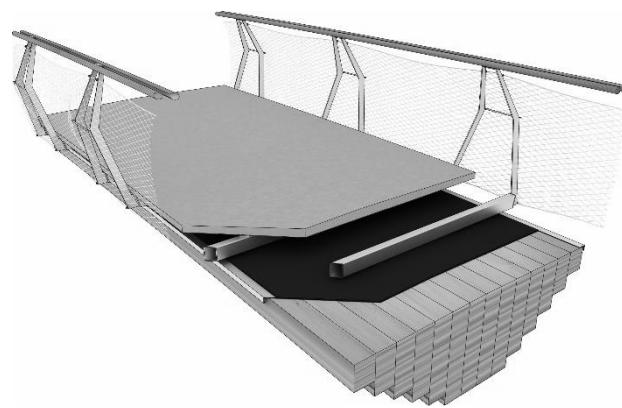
Isometrie Überbau mit Textilbeton-Gehbelag
